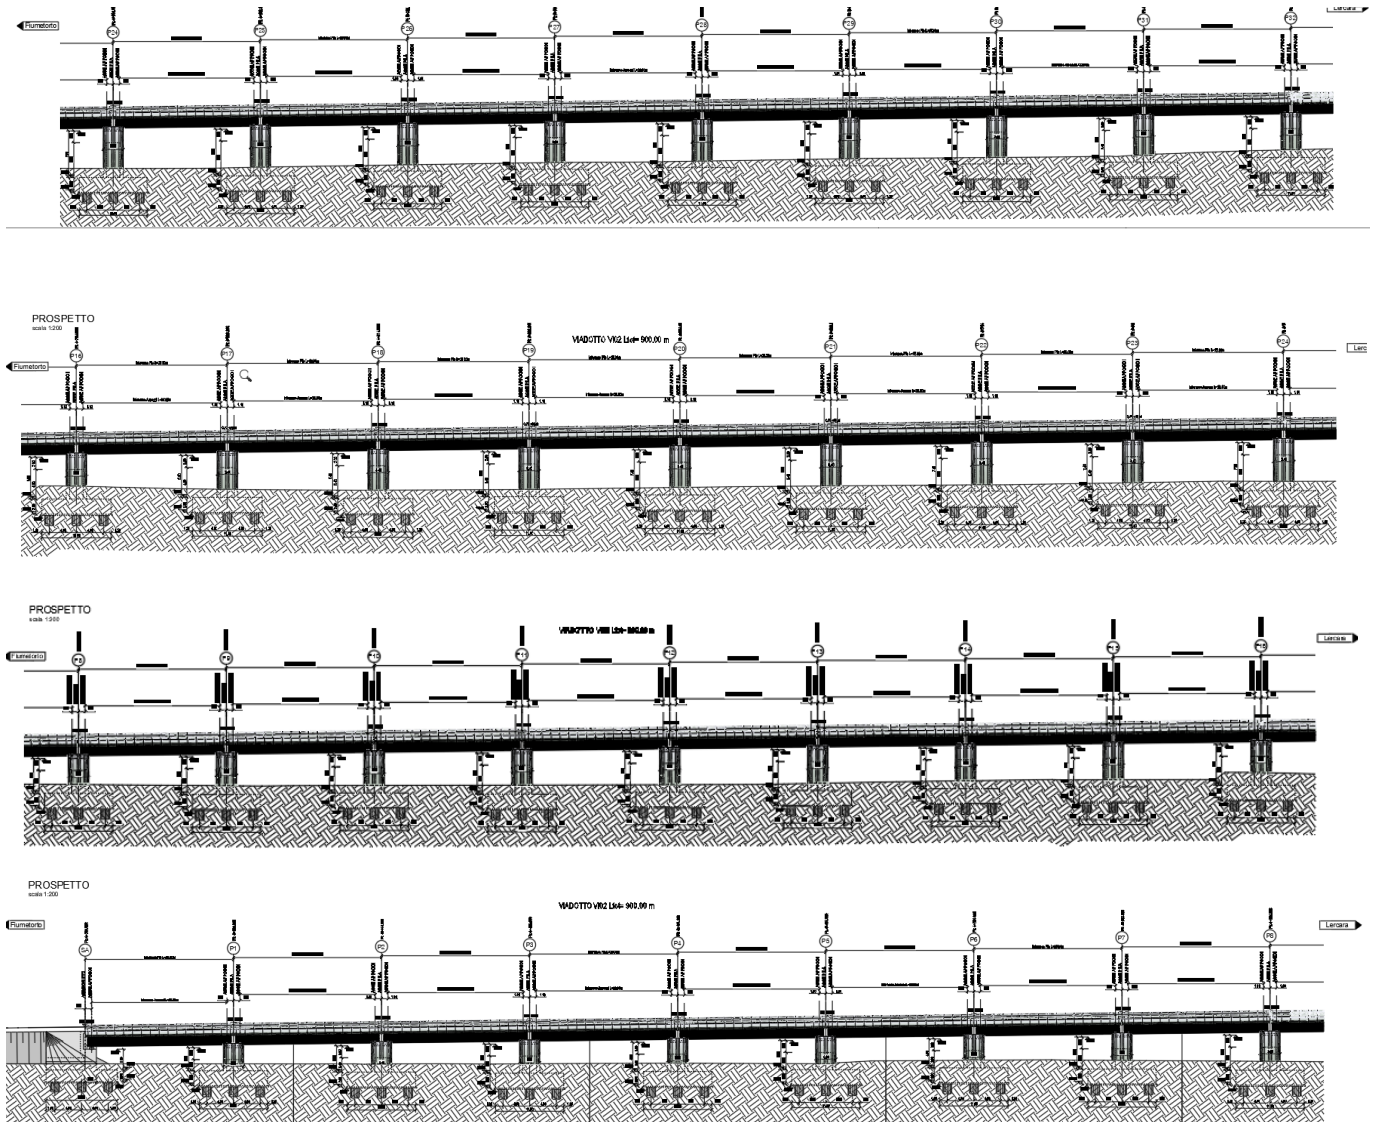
Viadotto VI02: sezione trasversale e prospetto
